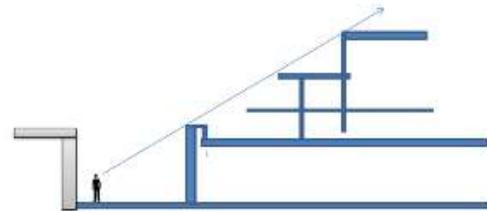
Alzado. Visual del transeúnte desde la calle. Elaborada por Javier García Barrera.
